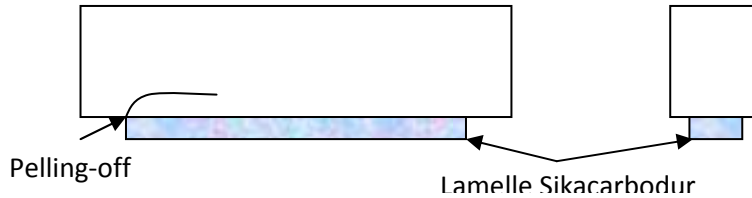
Renforcement poutre par Lamelle Sika Carbodur [13]
